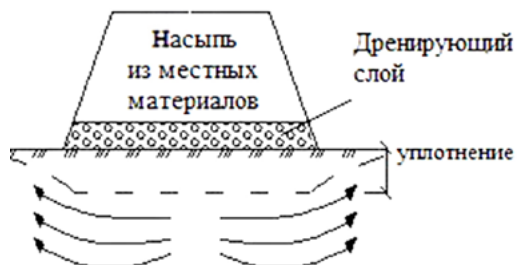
Схема гравитационного уплотнения слабых водонасыщенных грунтов в основании земляной насыпи
